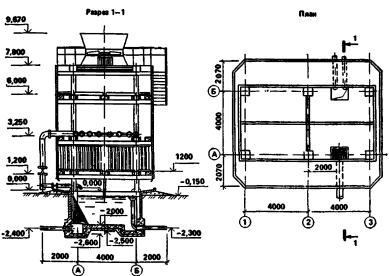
Градирик с вентиляторами ЗВГ25 брызгальные с секциями влощадыю 24 м² с каркасом из железобетонных элементов, Типовой проект 901-6-67,53 (к ценам J& 300—803)
